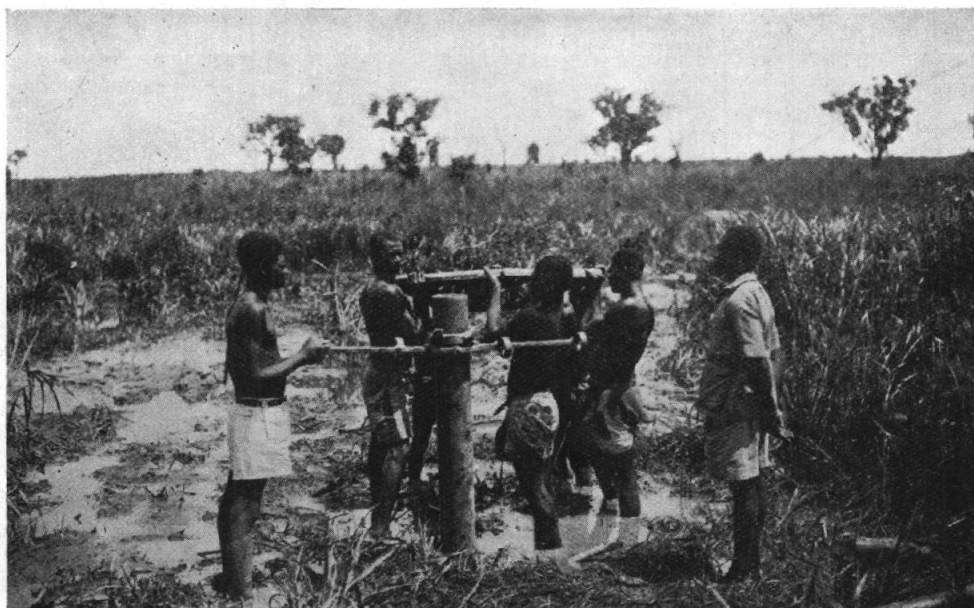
Photo 4. Mise en place d'une plate-forme d'une sonde Banka.
